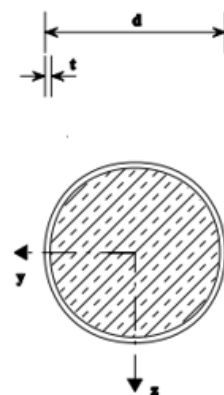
Perfil de un pilar mixto tipo CFT de sección circular
